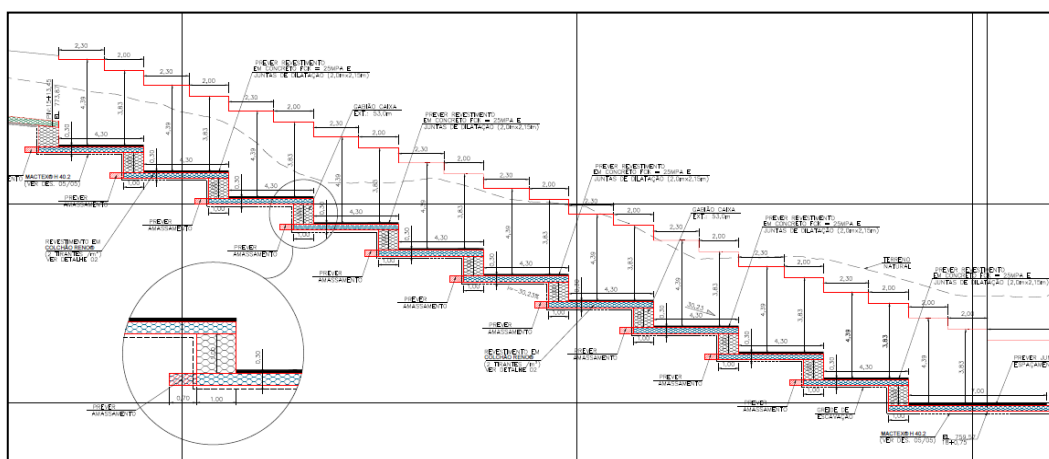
Trecho 3 do perfil longitudinal do extravasor correspondente a escada hidráulica
